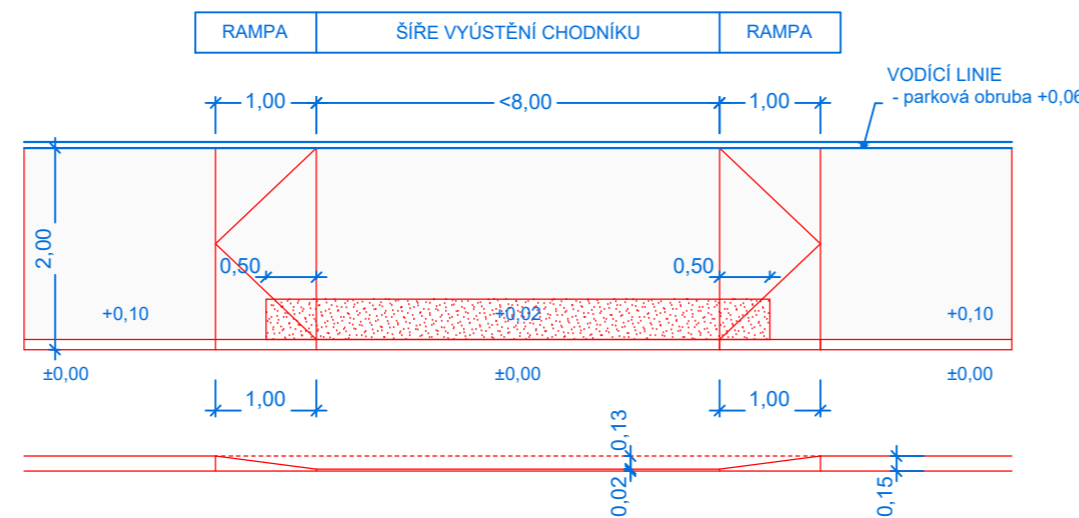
DETAIL PROVEDENÍ HMATOVÝCH ÚPRAV PŘECHOD PRO CHODCE M 1:75
